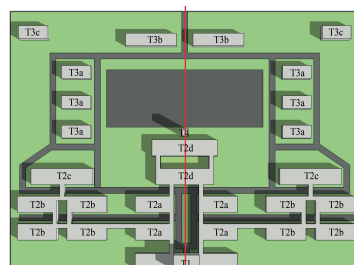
Planta de situação, demonstrando as tipologias existentes..
